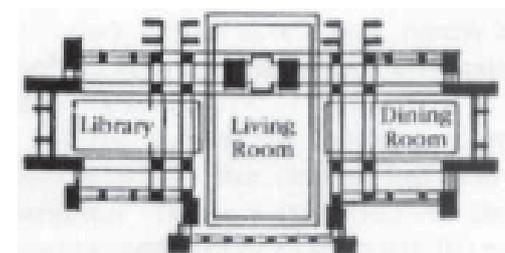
□ PLANTA DA DARWIN MARTIN HOUSE.
